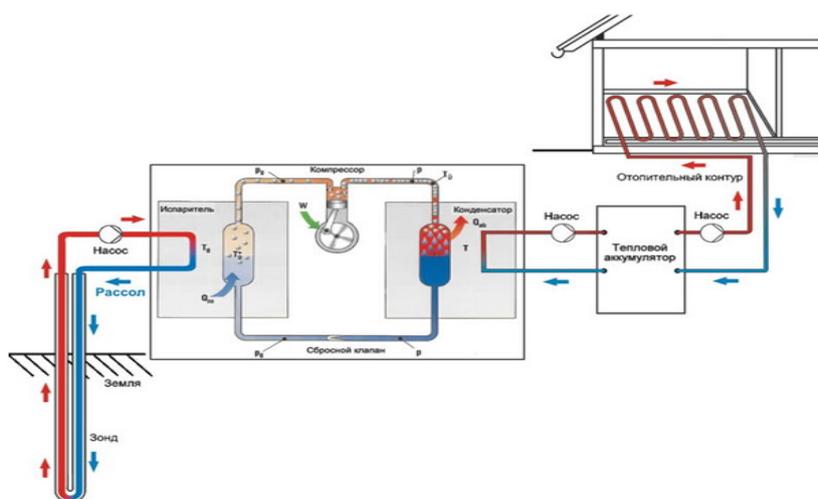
Схема использования теплового насоса, работающего по схеме «вода — вода»
